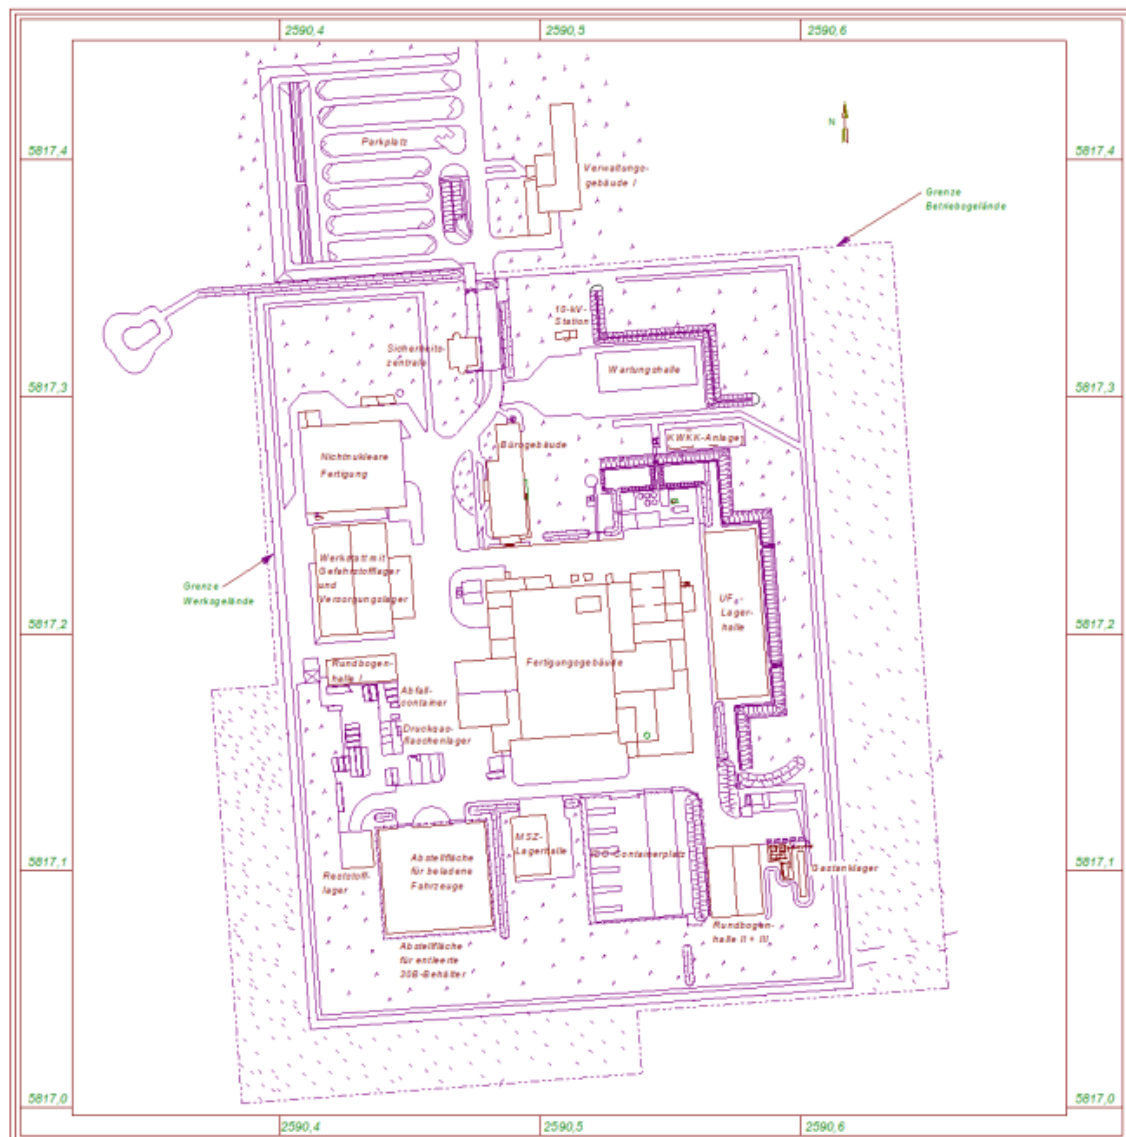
Werks- und Lageplan der Brennelement-Fertigungsanlage Lingen
